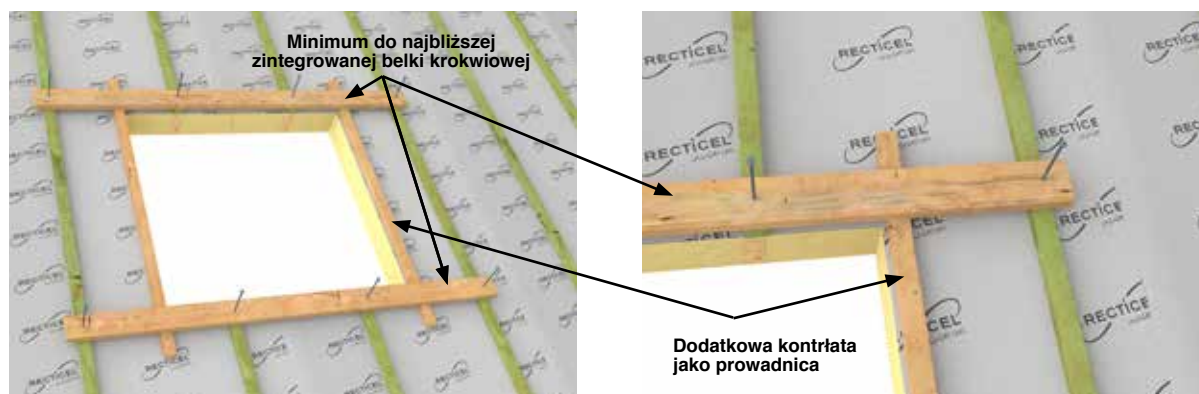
przygotowanie do wykonania otworu na okno dachowe
